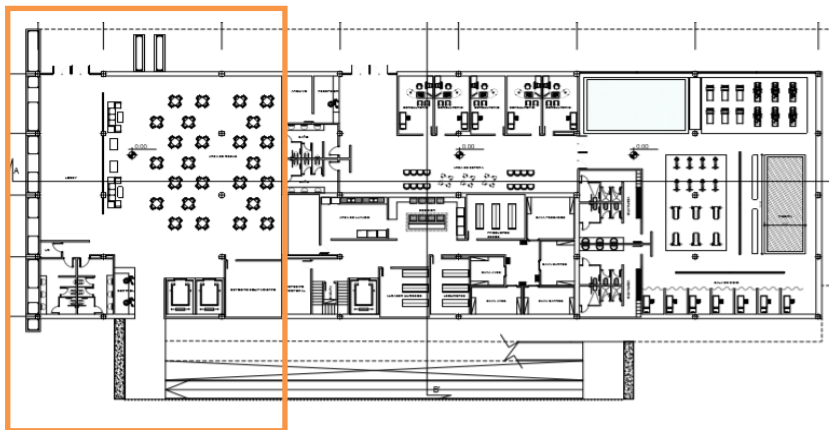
Planta Baja. Acceso. Nivel +0,00m. (2020)
